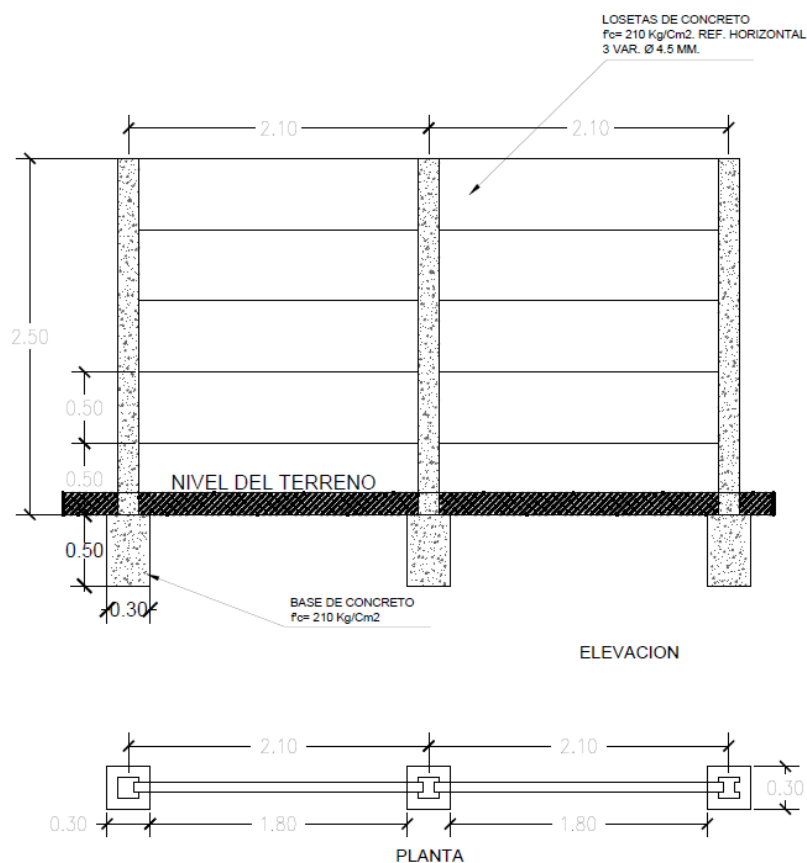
20. Vista general de detalles constructivos de tapial perimetral.
